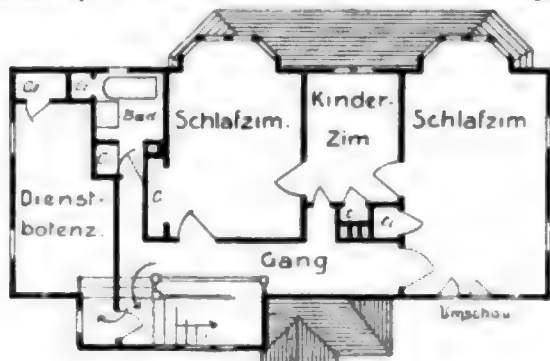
OBERGESCHOSS DES AMERIKANISCHEN LANDHAUSES im Grundriss.
